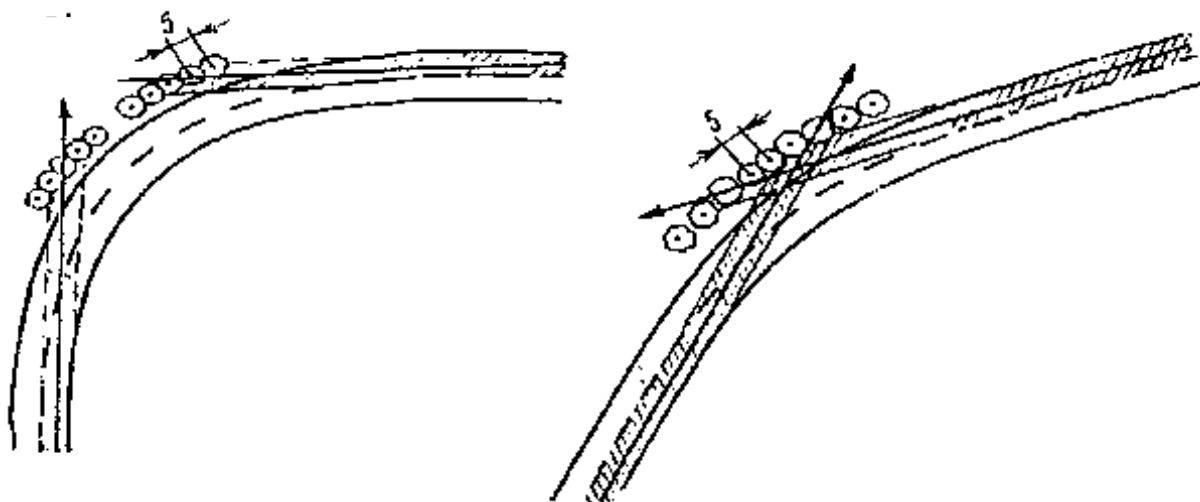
Пример (схема) направляющих посадок на кривых в плане для целей зрительного ориентирования
